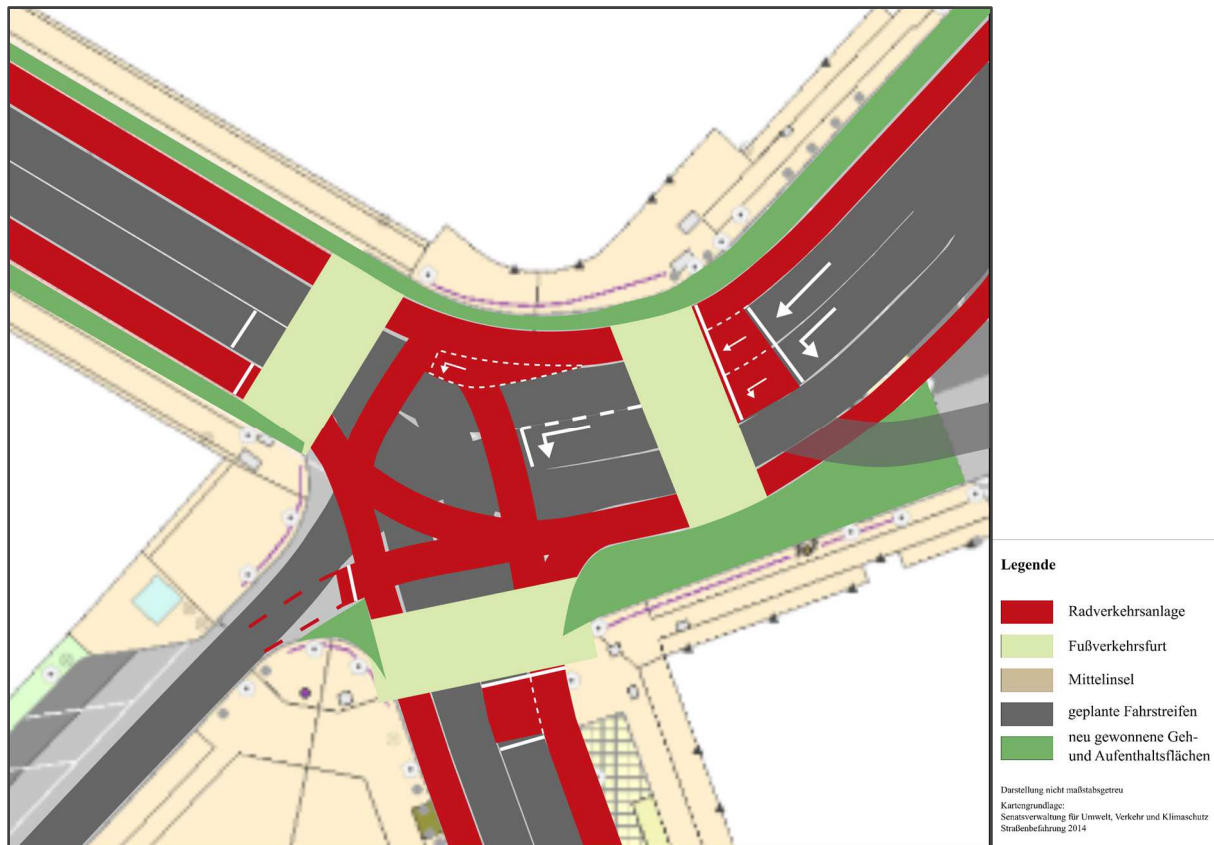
Planskizze Knotenpunkt Königsberger Straße / Kranoldplatz / Oberhofer Weg / Brauerstraße
